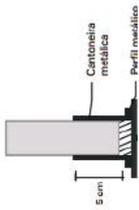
Fixação de cantoneiras nos perfis metálicos.
